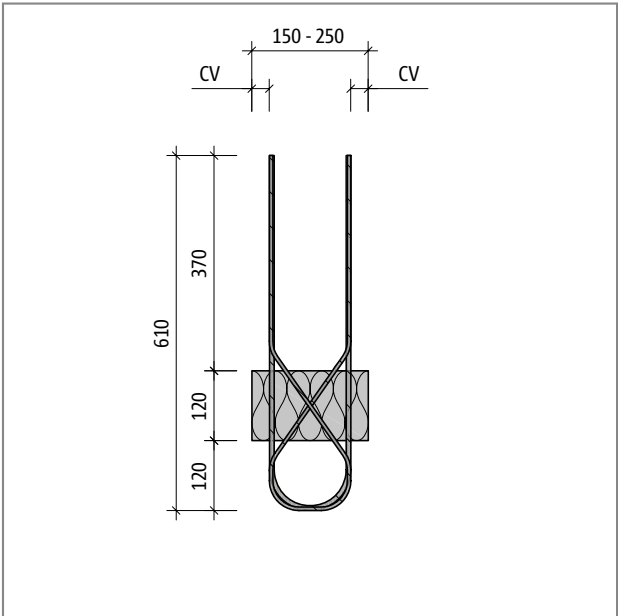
Schöck Isokorb® tipo ABXT: sezione trasversale del prodotto
